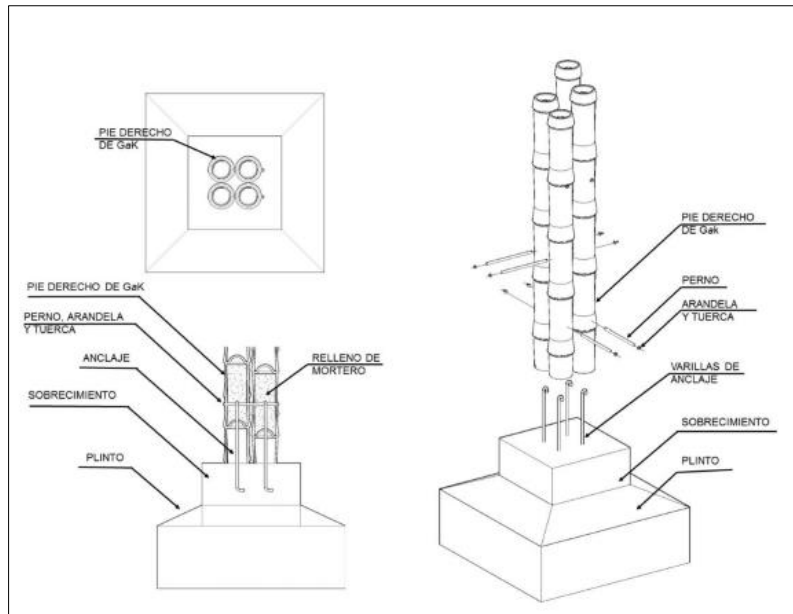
Detalle de conexión de cimiento y plinto, estructura GaK
